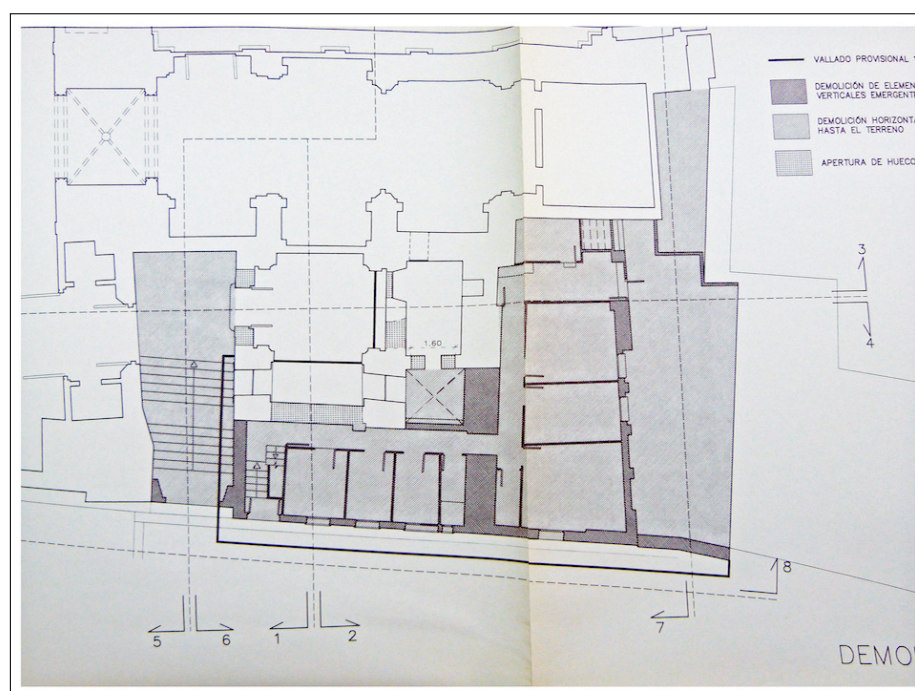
En color gris, demoliciones efectuadas en la planta baja del conjunto
